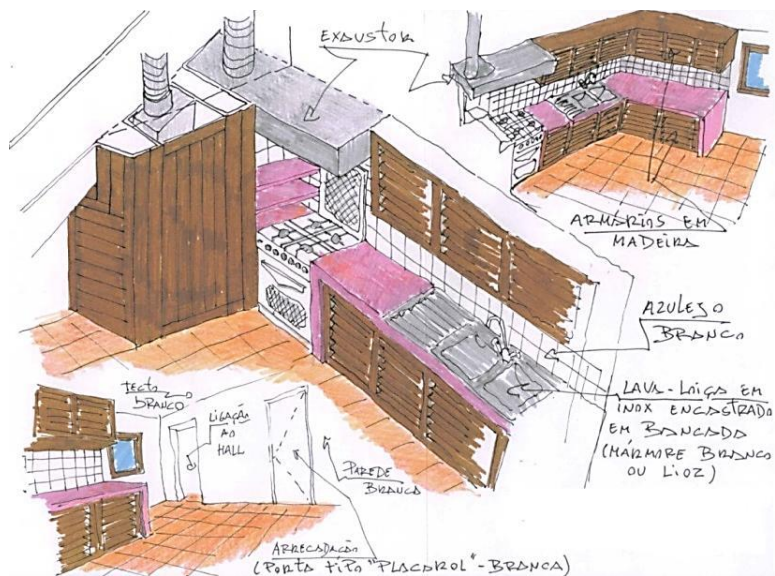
Vistas da proposta (interior) - cozinha no piso térreo
